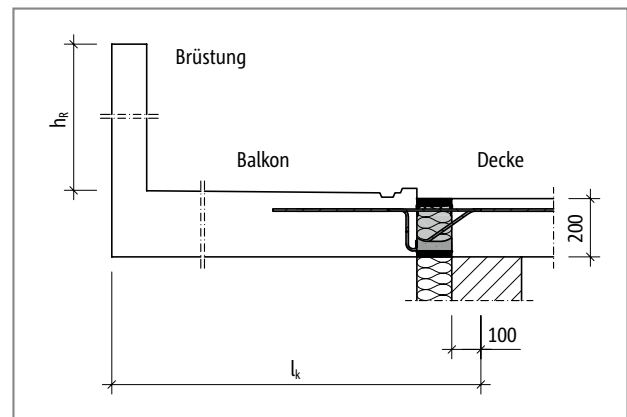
Schöck Isokorb® XT Typ KL: Statisches System
